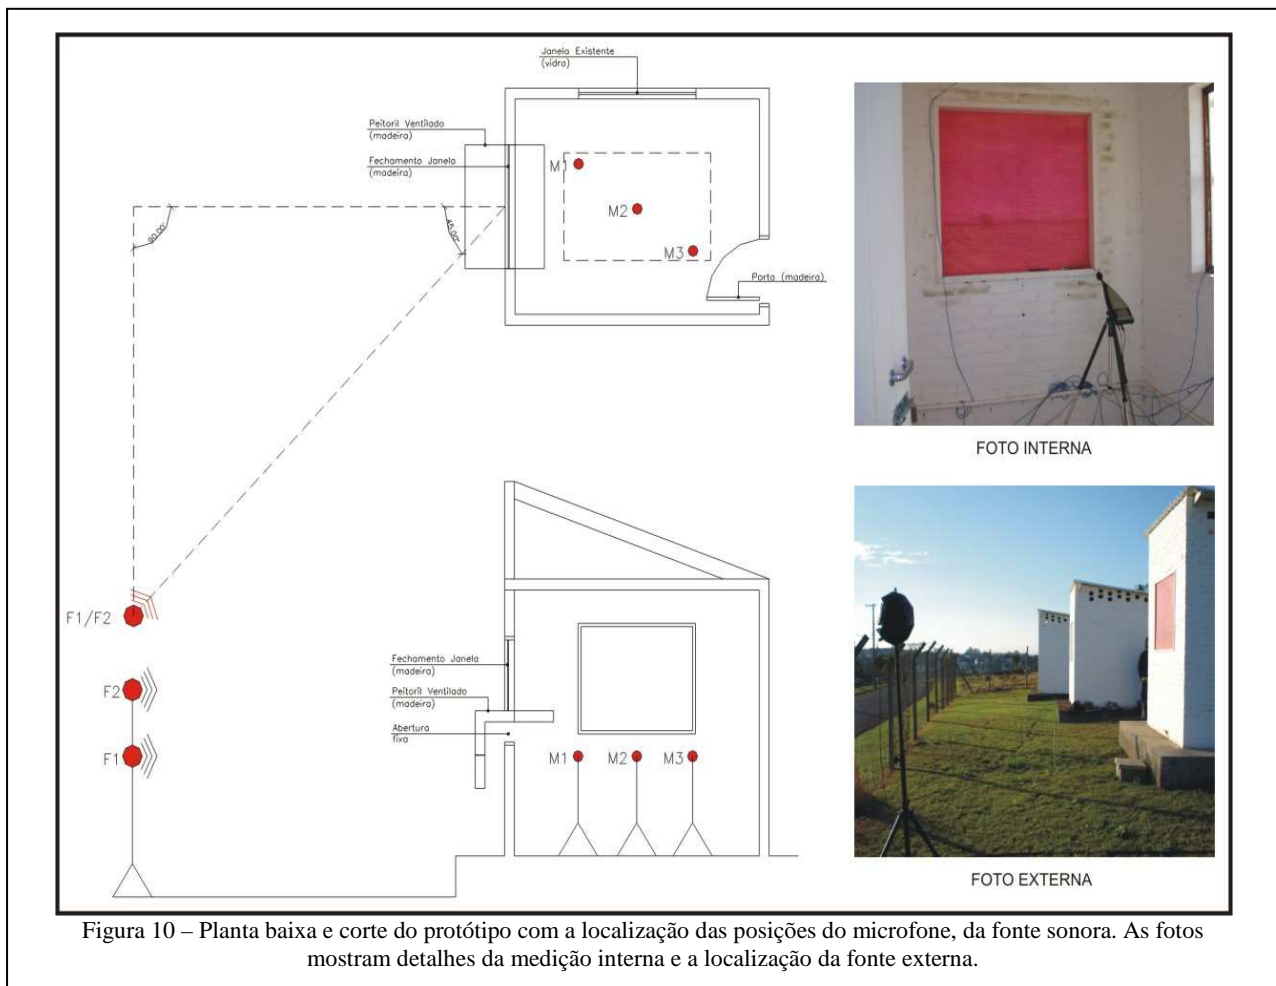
Planta baixa e corte do protótipo com a localização das posições do microfone, da fonte sonora. As fotos mostram detalhes da medição interna e a localização da fonte externa.
